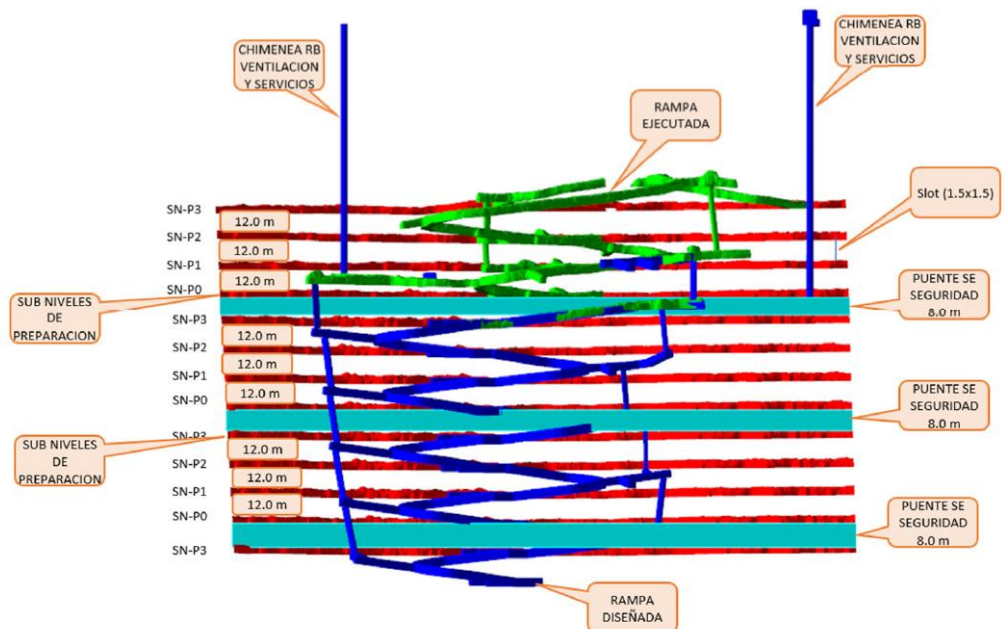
Vista longitudinal minado Bench and Fill (avoca) con relleno detrítico
